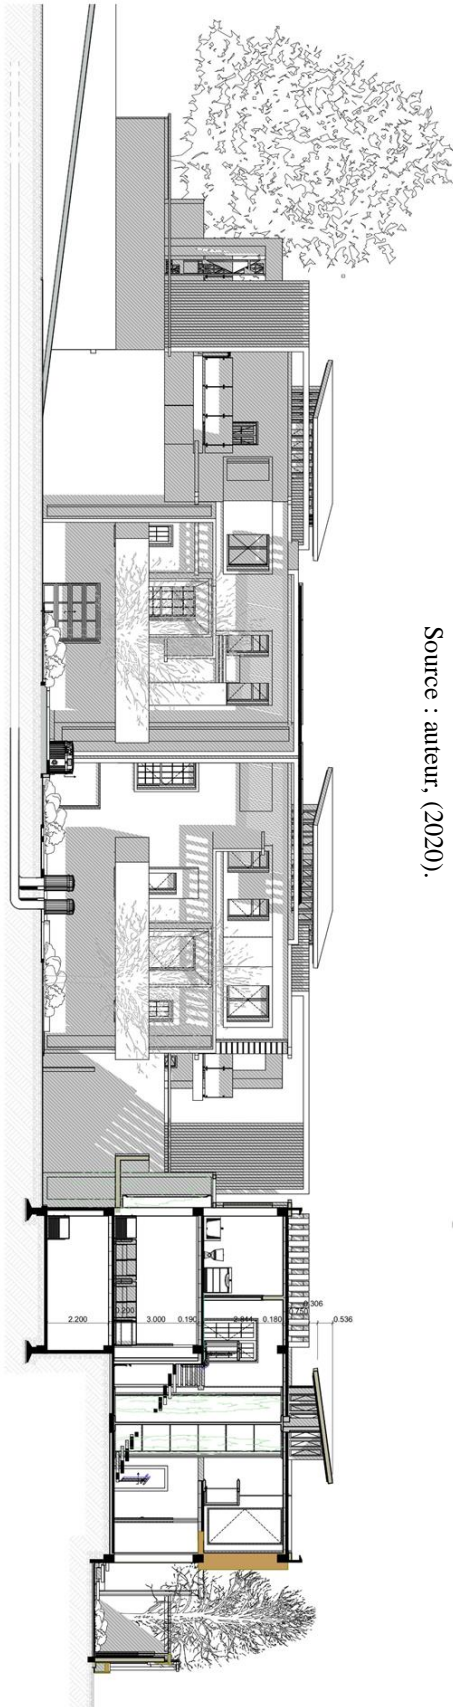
Coupe Façade BB' (F4/F5/F5), éch 1/100.
